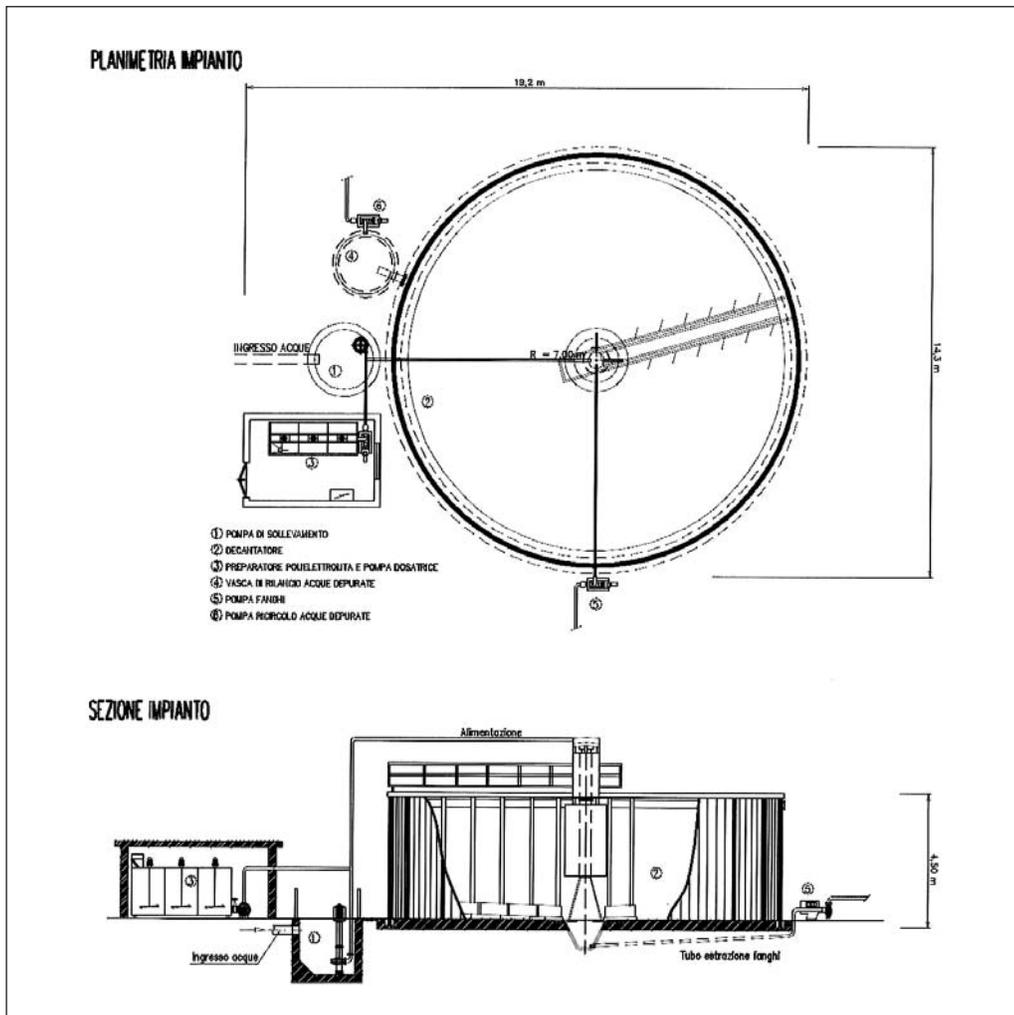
Planimetria e sezione di un impianto di chiariflocculazione delle acque di lavaggio inerti.
